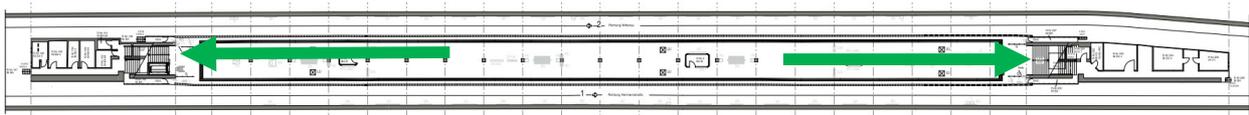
zeigt den Lageplan des U-Bahnhofs Heinrich-Heine-Straße.
